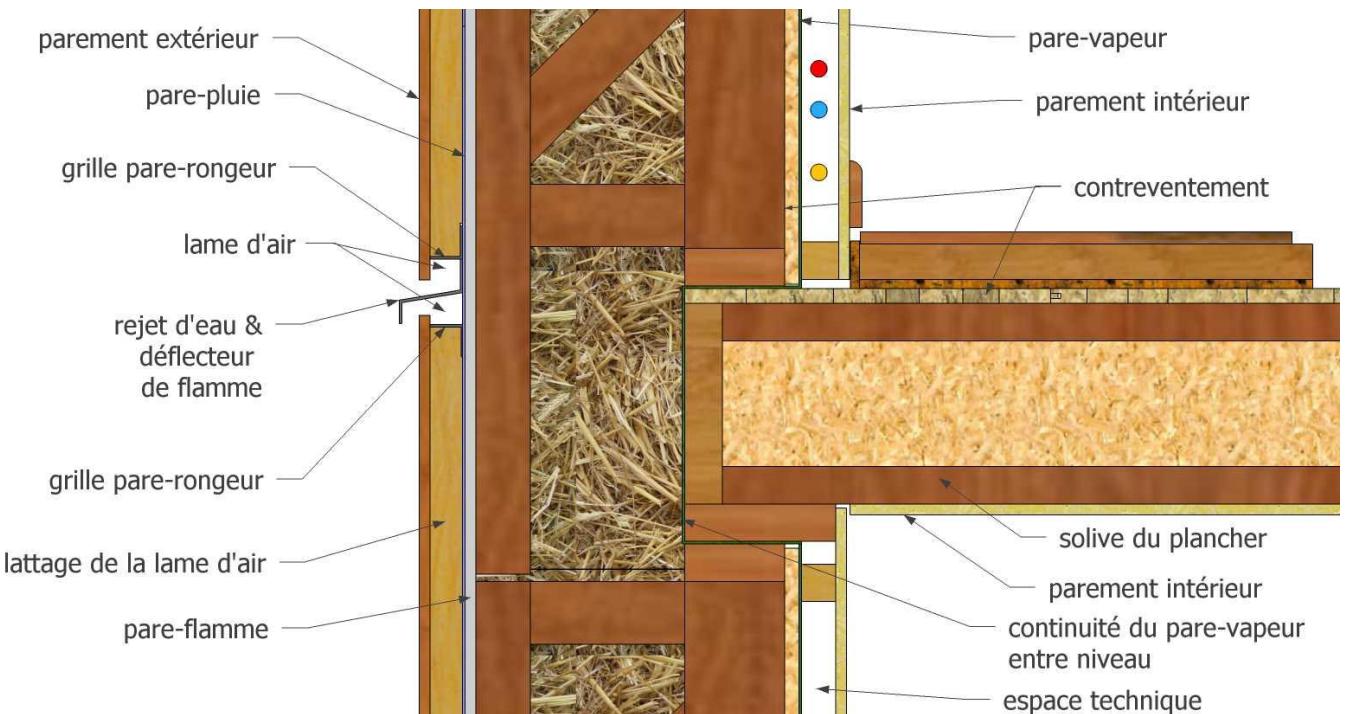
Jonction plancher – mur, continuité du pare-vapeur
